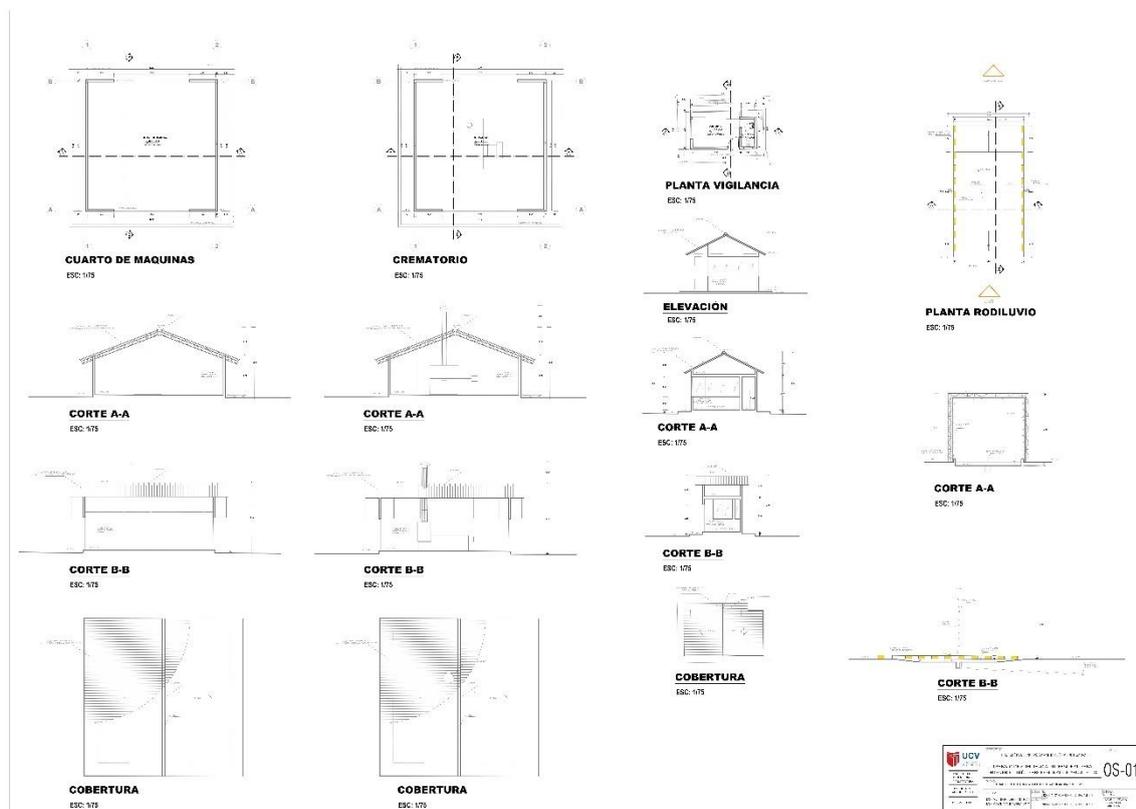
Plano de Detalles de Cuarto de máquinas, Vigilancia y Crematorio
